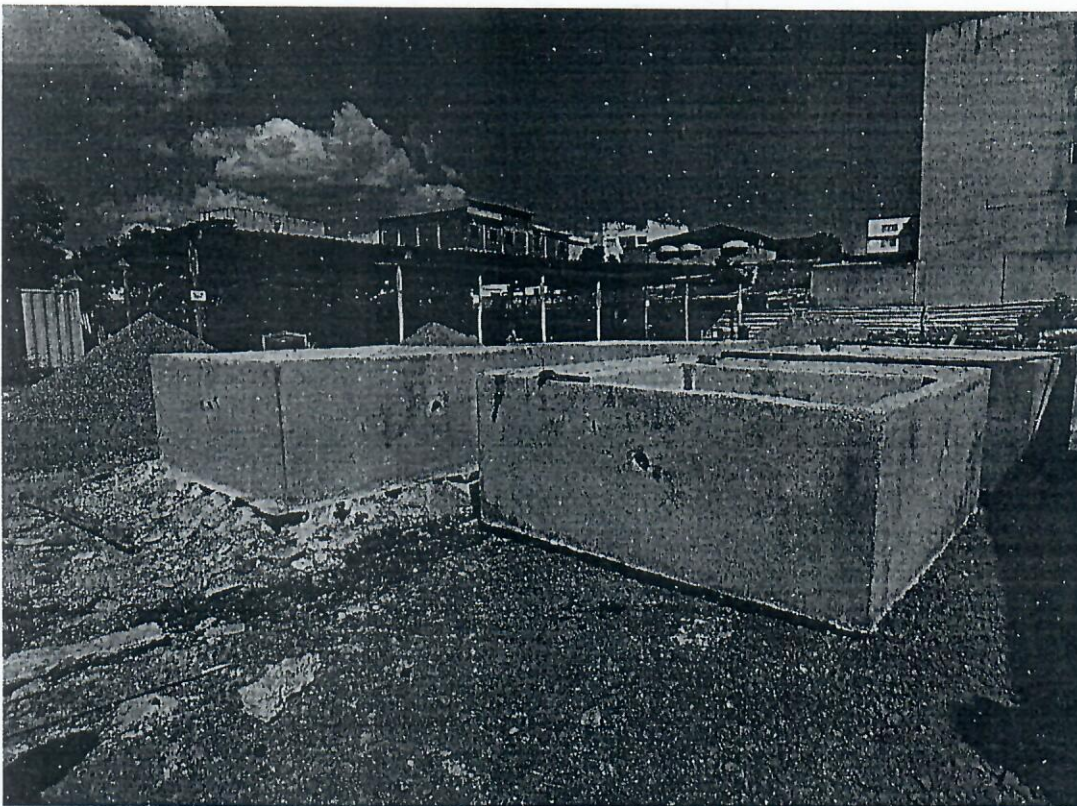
GALERIA DE CONCRETO CELULAR NÃO EXECUTADO
